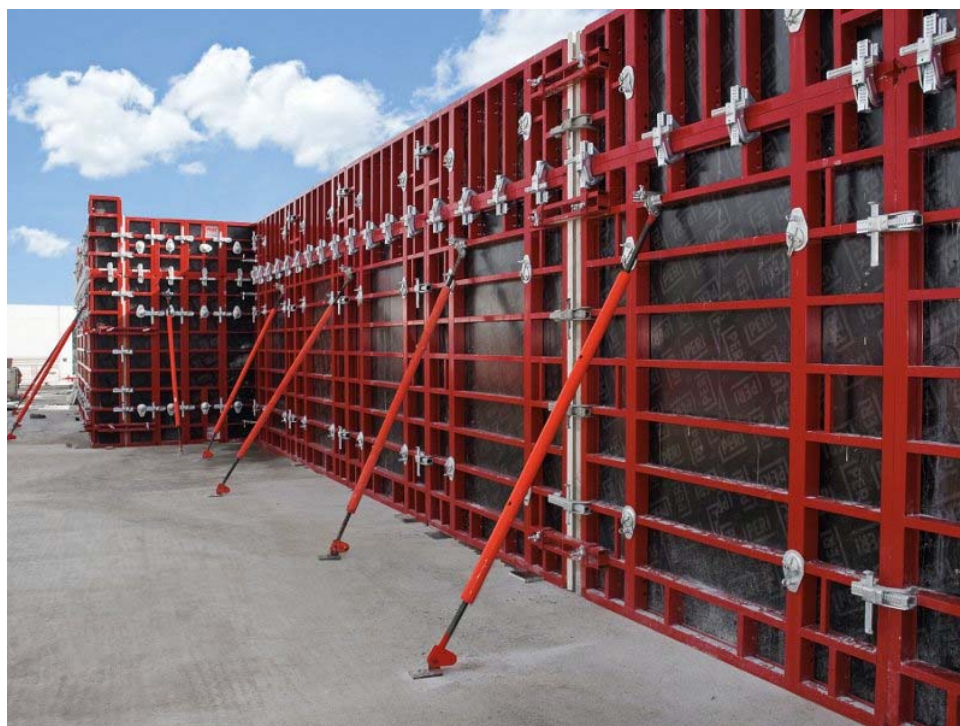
Muro de hormigón armado encofrado a 2 caras.
